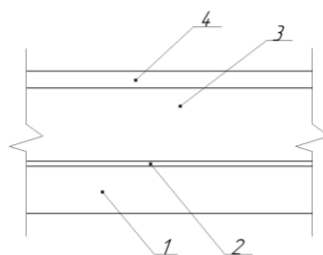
Устройство перекрытия по холодному чердаку:
